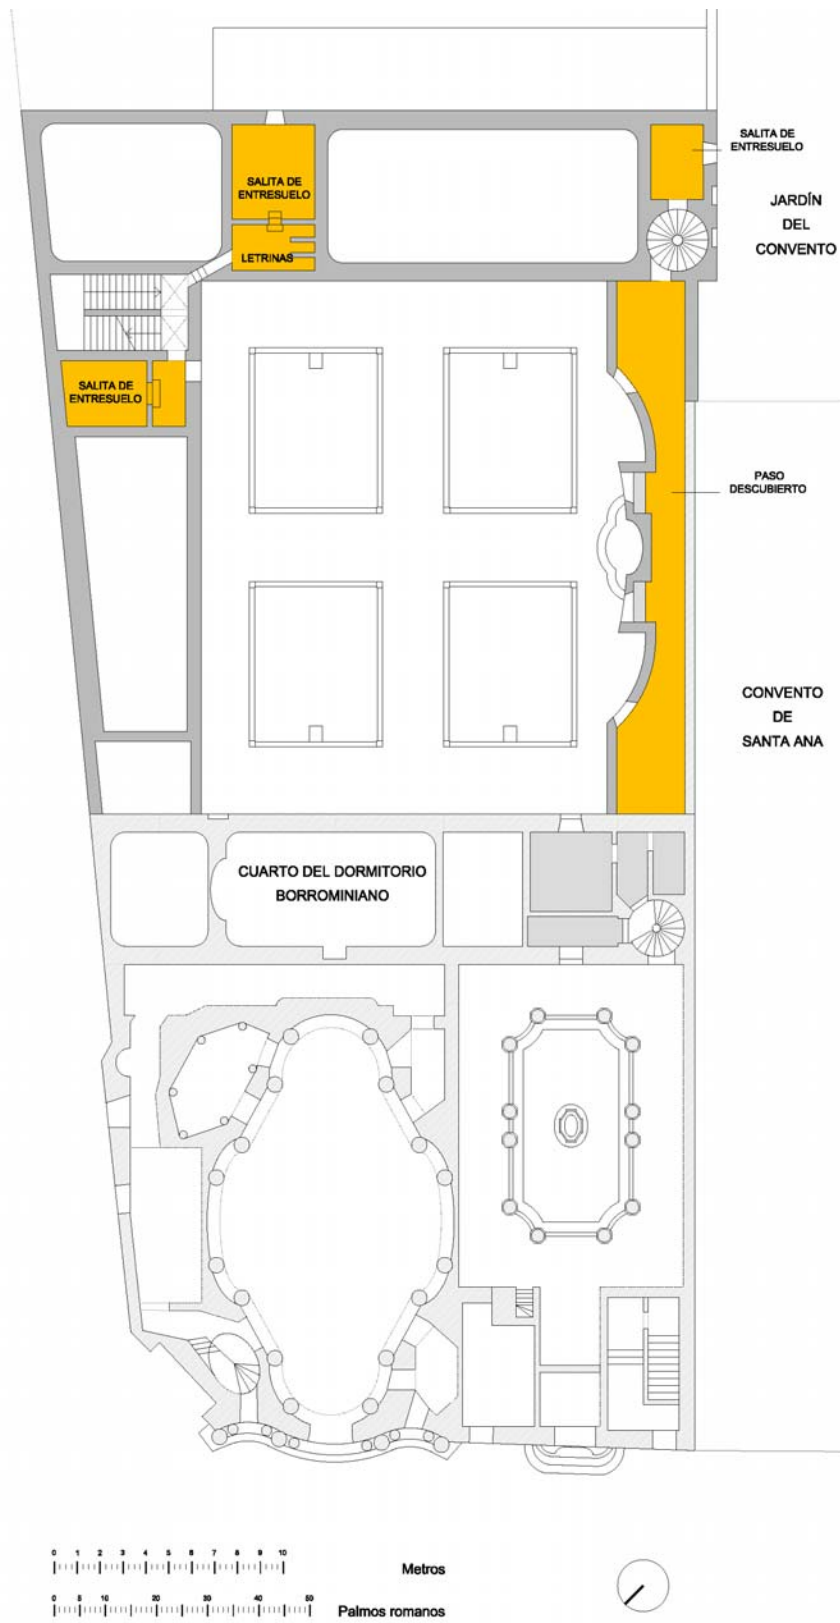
Disegno dell'autrice. Pianta dei mezzanini.
